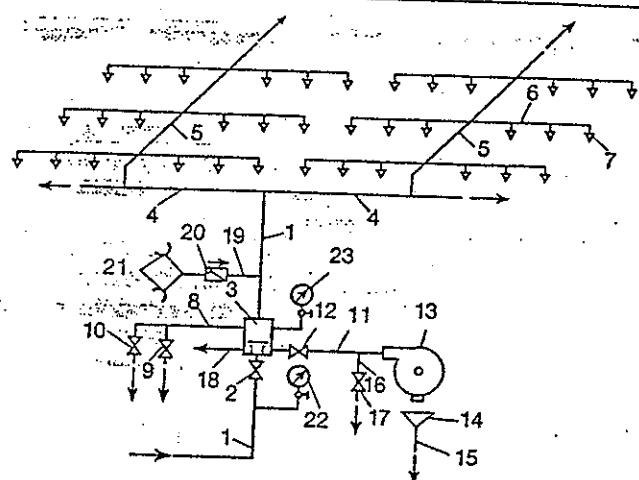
Schema de funcționare automată a instalației cu sprinklere în sistem apă - apă:
